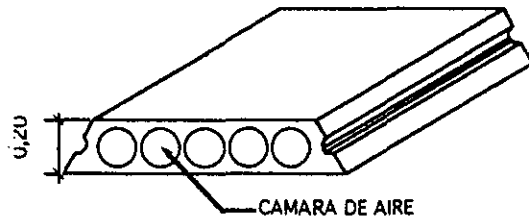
Esquema del sistema empleado para losas de techos y entrepisos. Sistema prefabricado Hollowcore Slabe tipo PRETINSA Industrial.
